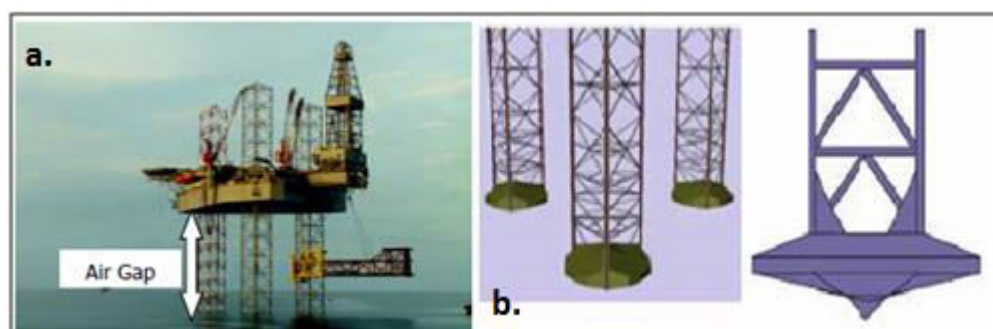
a. Air gap d'une plateforme autoélevatrice. b. Les caissons des piles. [4]
